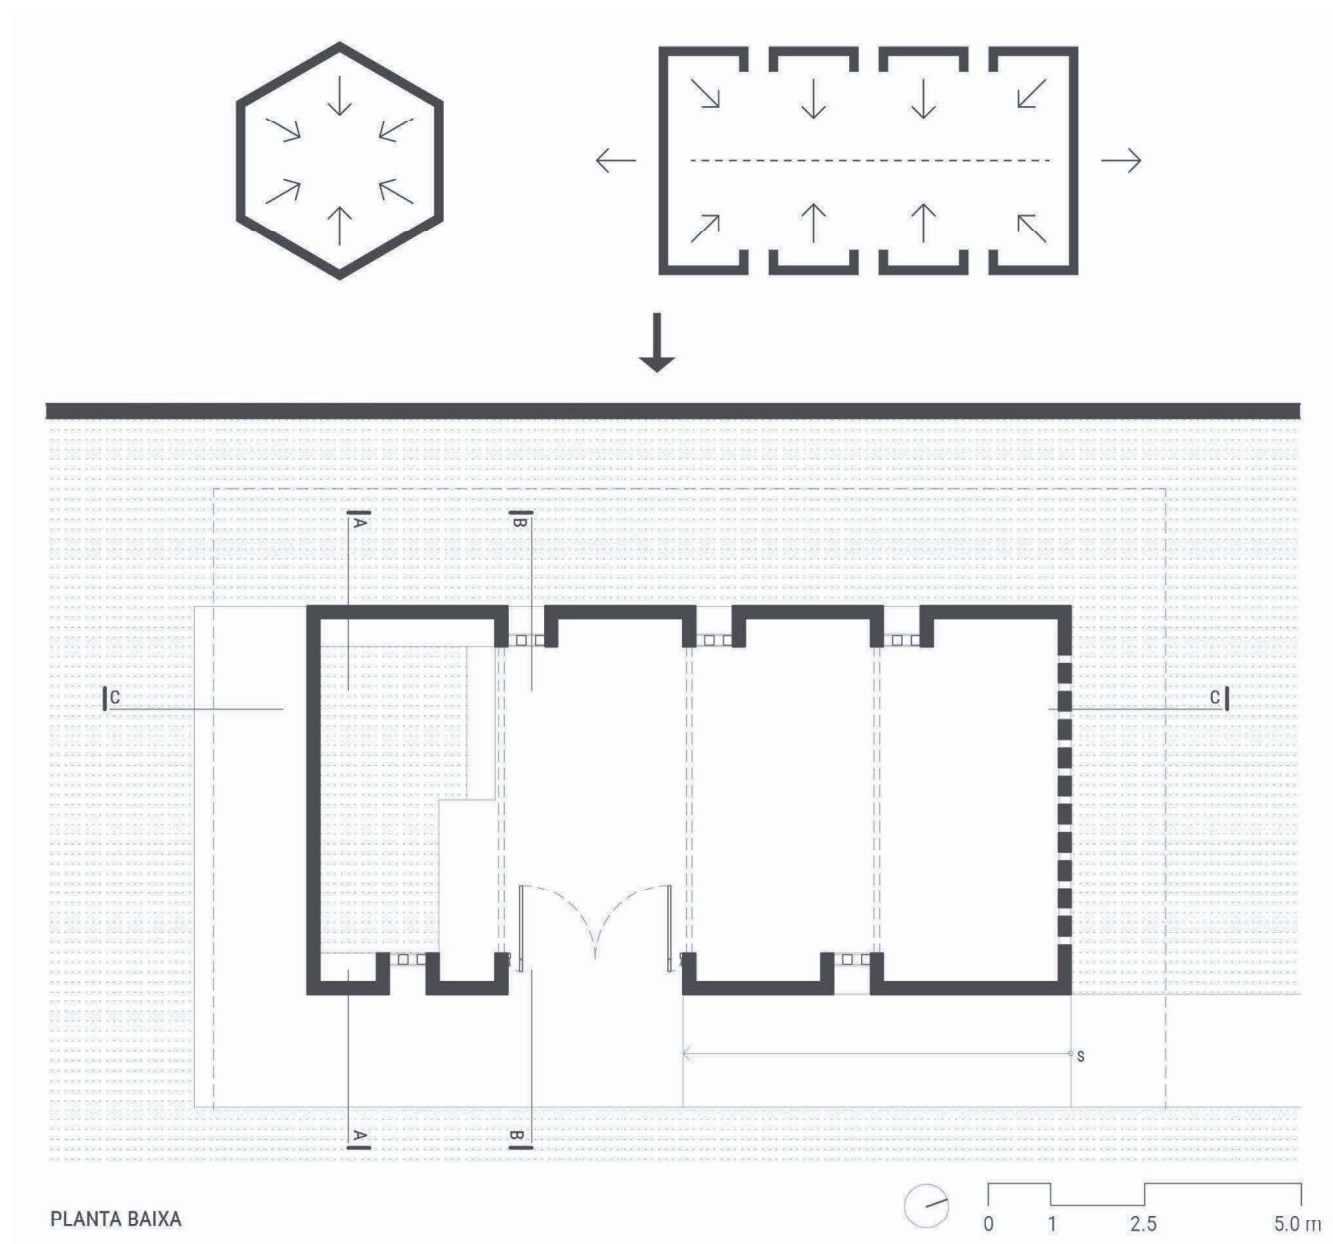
Processo de abstração do diagrama em planta para planta baixa final da edificação. Fonte: Acervo Rede Arquitetos, 2022.
